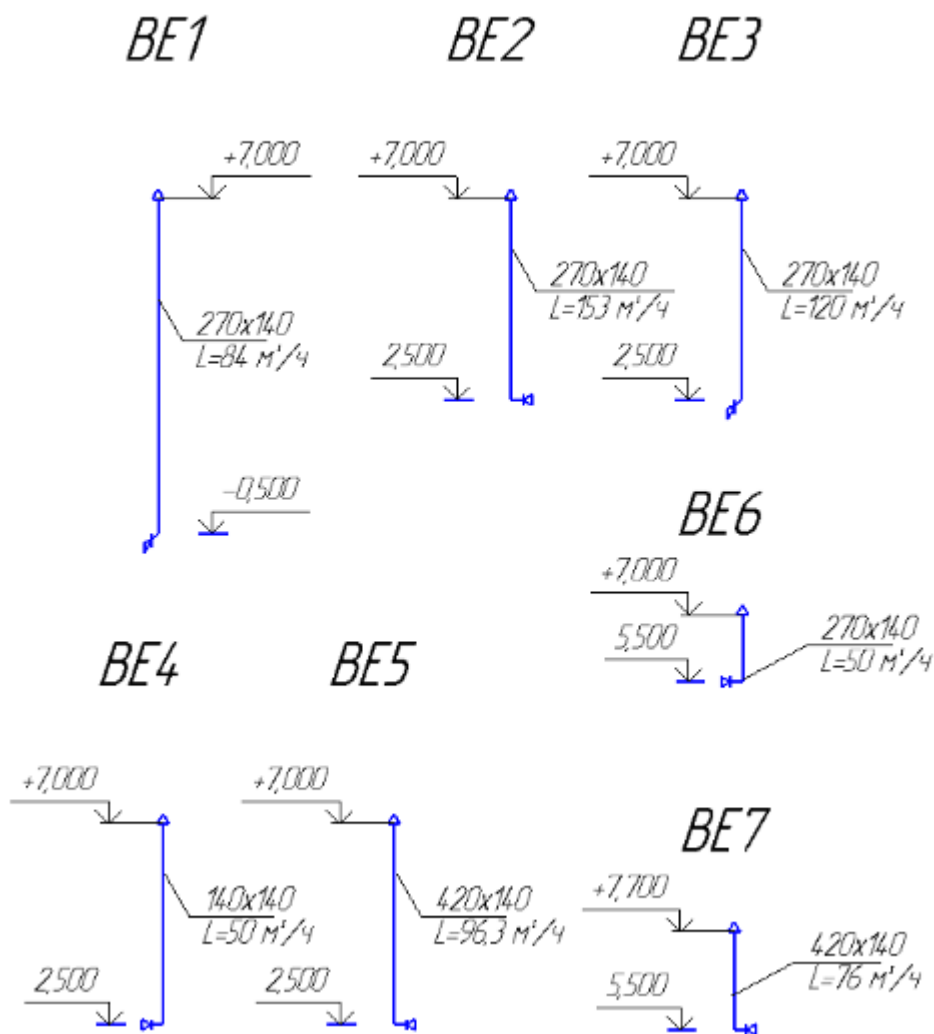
Расчетная схема систем вентиляции BE1-BE7
